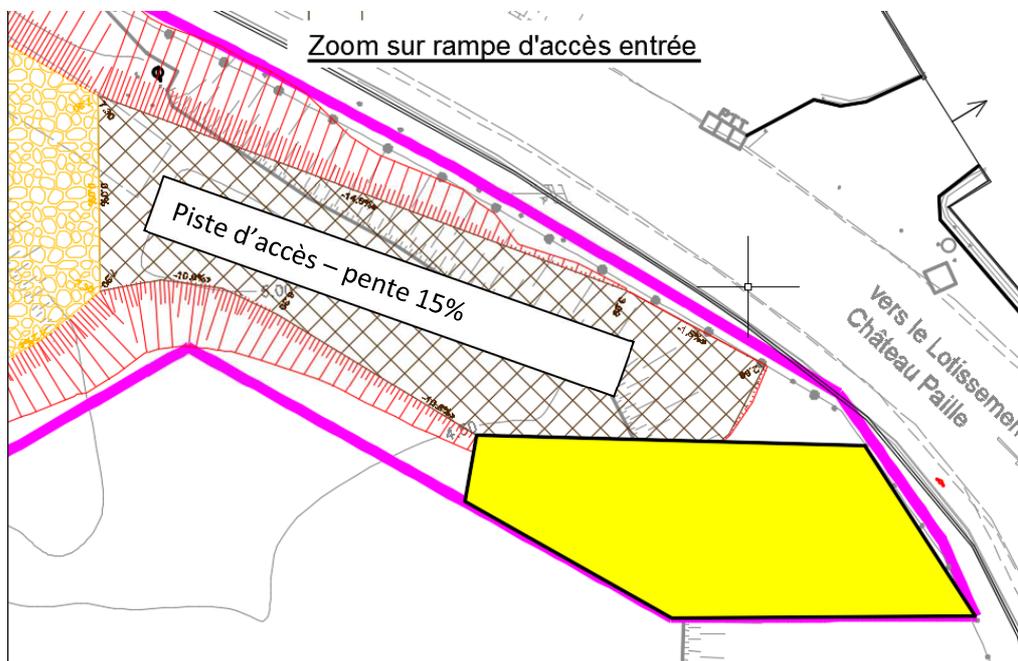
Extrait du plan avec localisation des rampes (source : SAFEGE 2018)
